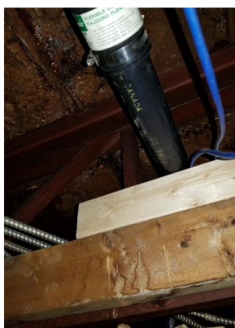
Endommagement de la structure du plancher du rez-de-chaussée
